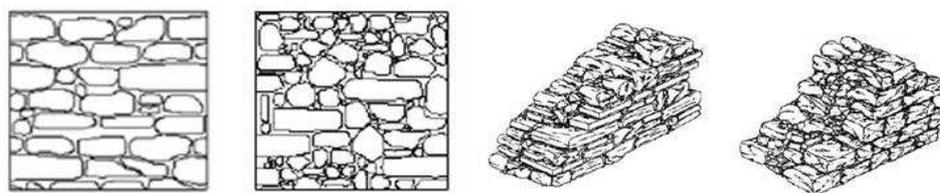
Tipo de assentamento, aparelho e secção transversal [3, 4]
